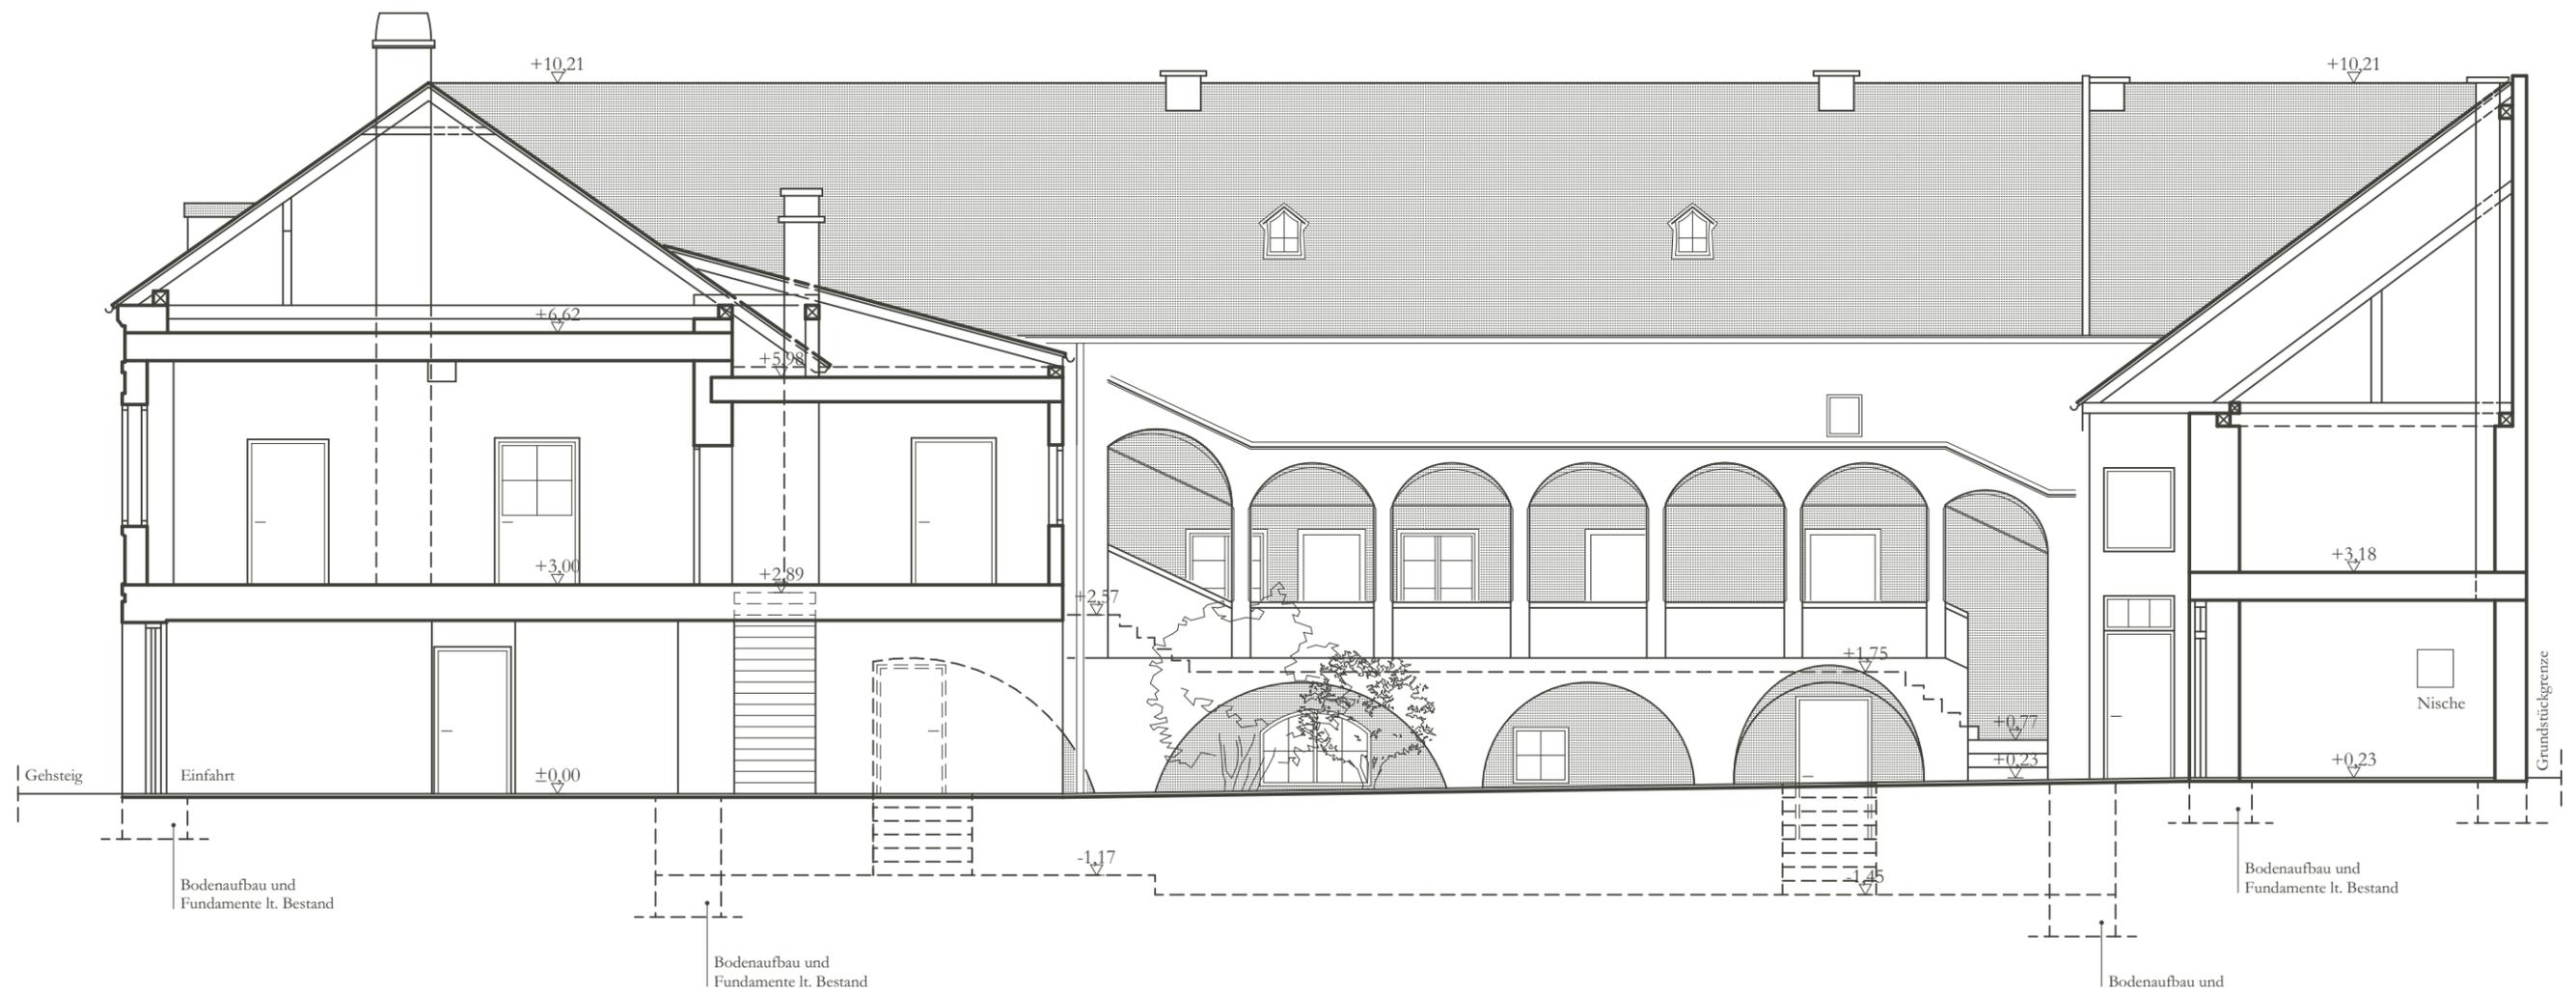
Bestandsplan Schnittansicht A-A, M 1:100
